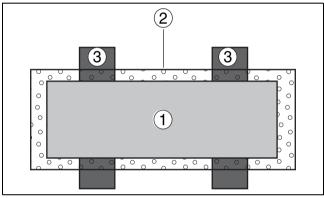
Наружный блок на напольной конструкции (вид сверху)
